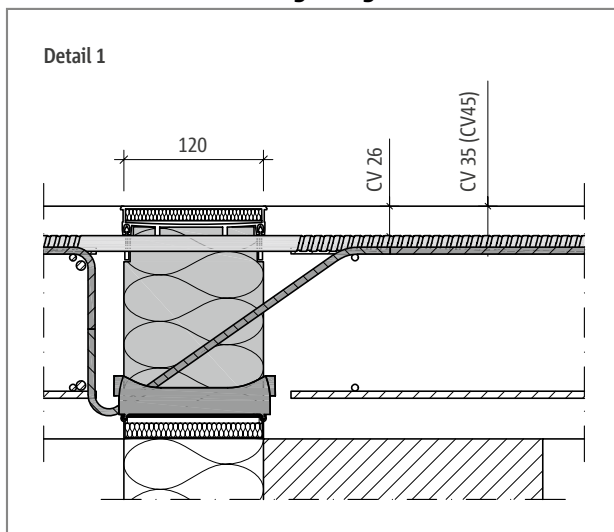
Schöck Isokorb® CXT Typ K-CV26: Betondeckung der Querkraftstäbe CV35 (CV45 bei ungeraden Isokorbhöhen)
